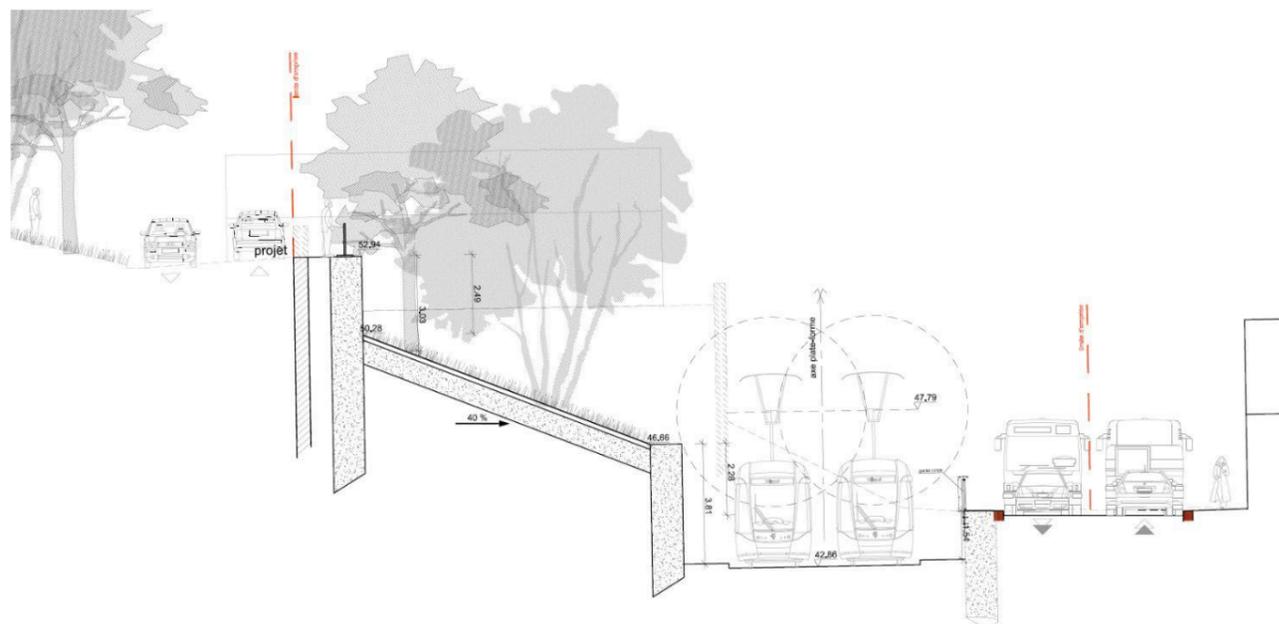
Coupe type au niveau de la tranchée ouverte de sortie du tunnel au droit de la rue Piver
